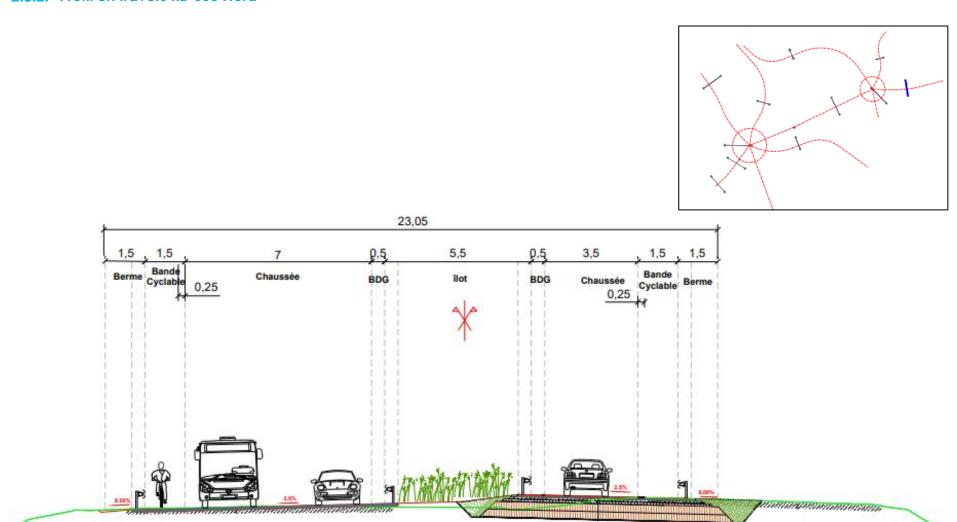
Profil en travers de la RD 650 Nord au 1/100 (Source Ingerop)
